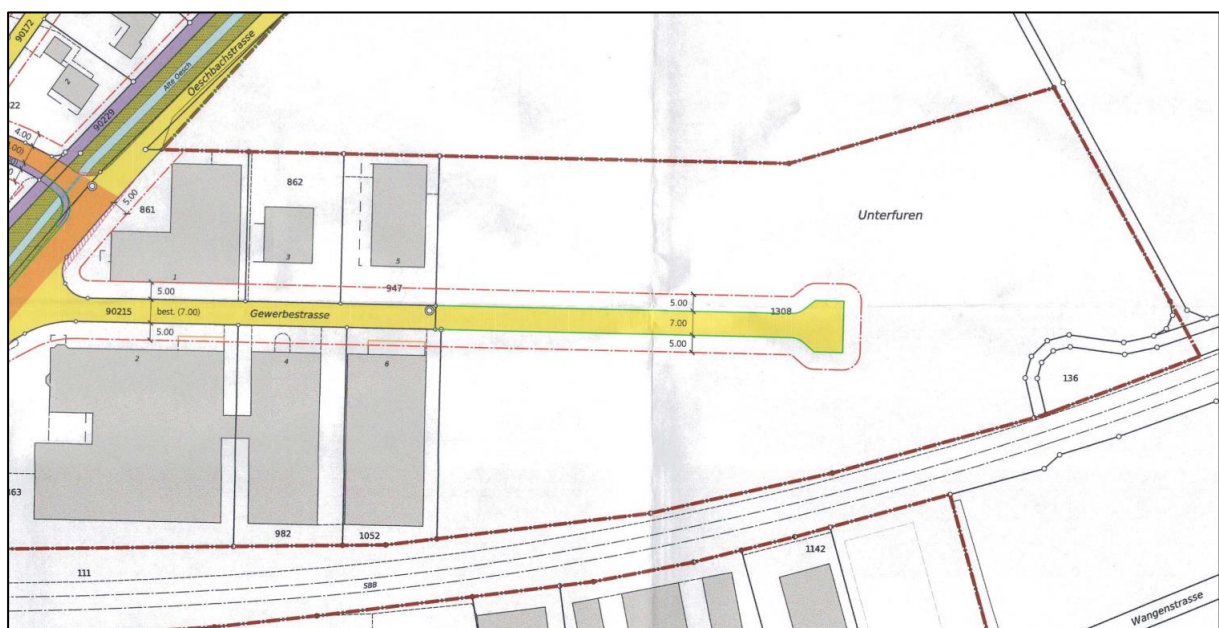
Ausschnitt Erschliessungsplan Deitingen (Plan Ortsteil Mitte)
